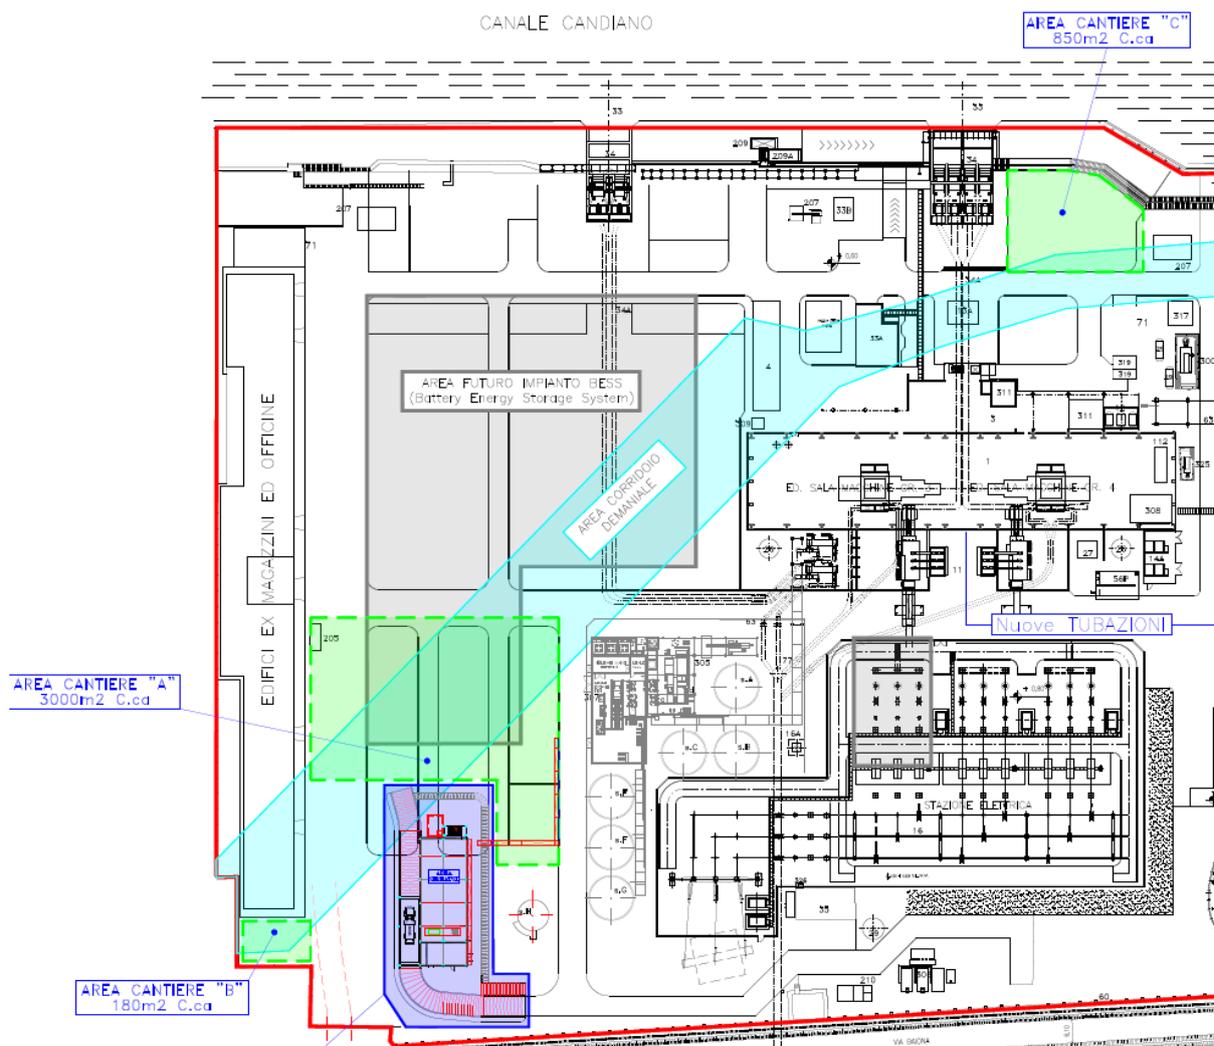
Planimetria di progetto con aree di cantiere
